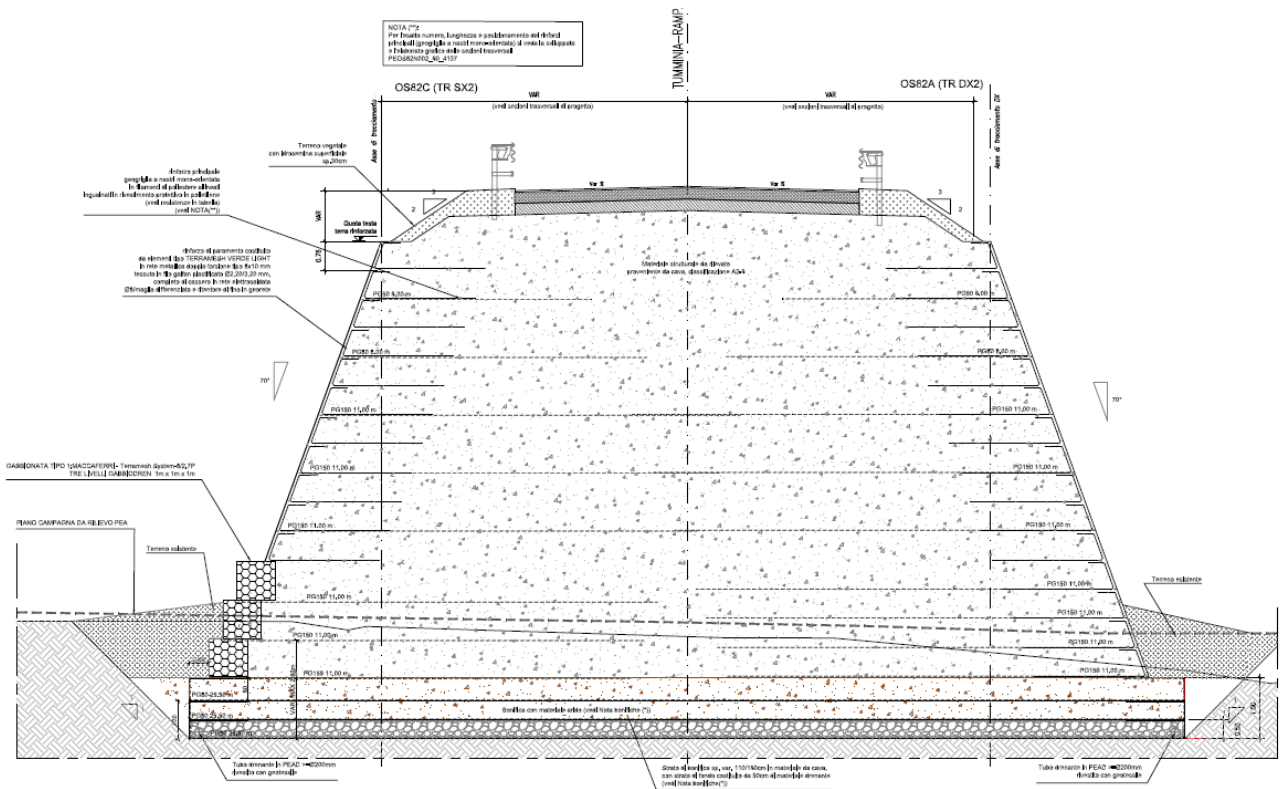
Sezione tipologica con protezione sulla Rampa 1
